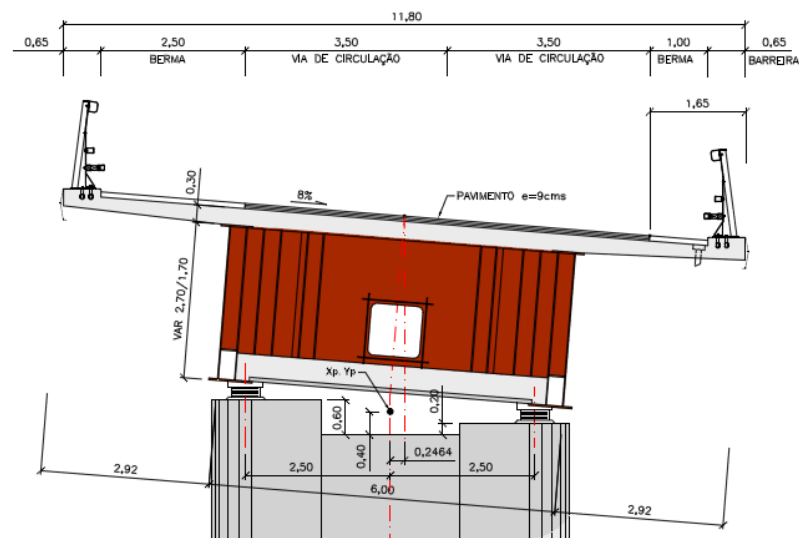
Secção transversal da Ponte Ute – Nueno em zona de apoio
